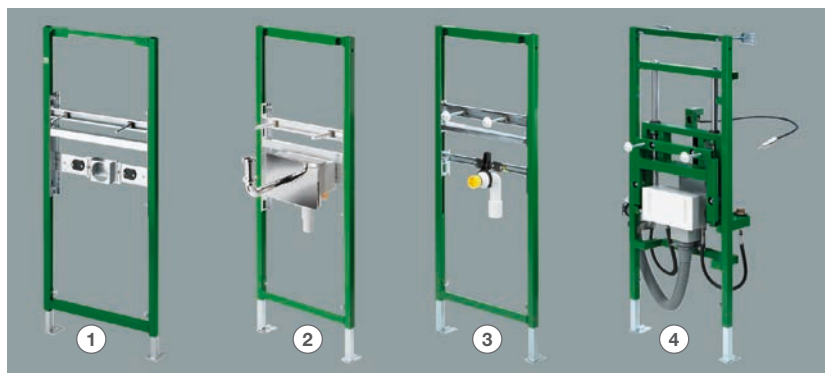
46 Viega Eco Plus – Estruturas de lavatório
